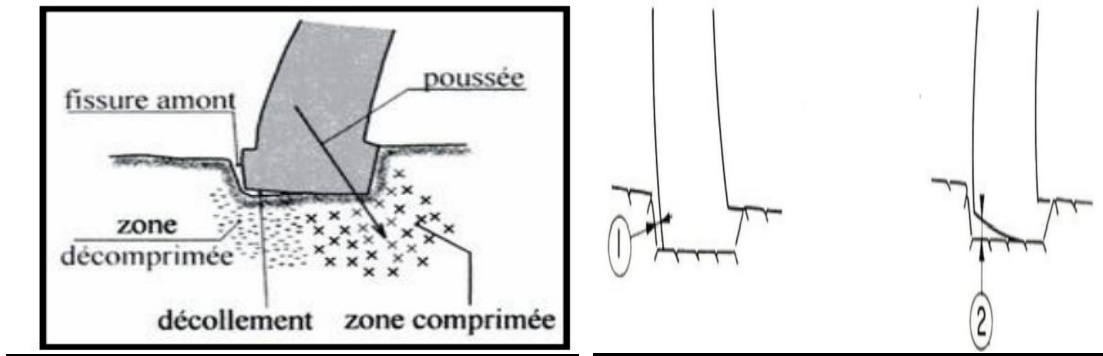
Direction et l'ampleur de la force de poussée de la fondation au niveau de l'interface barrage voûte-fondation (FERC, 2018)
